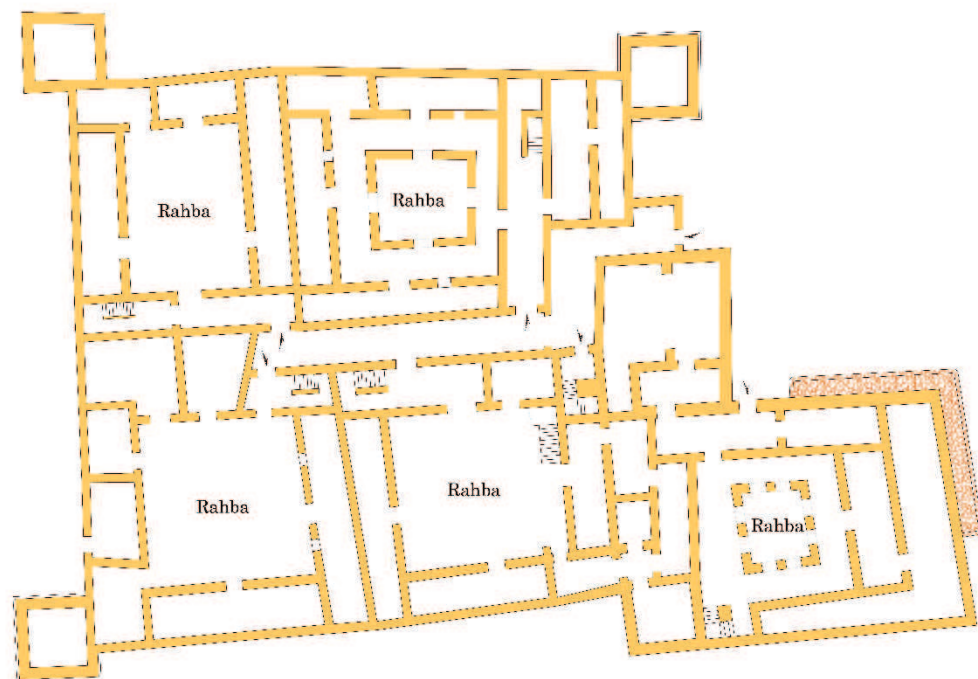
Vue en plan de la Gasbah d’Ahl-Bellaameche, (échelle : 1/200).
